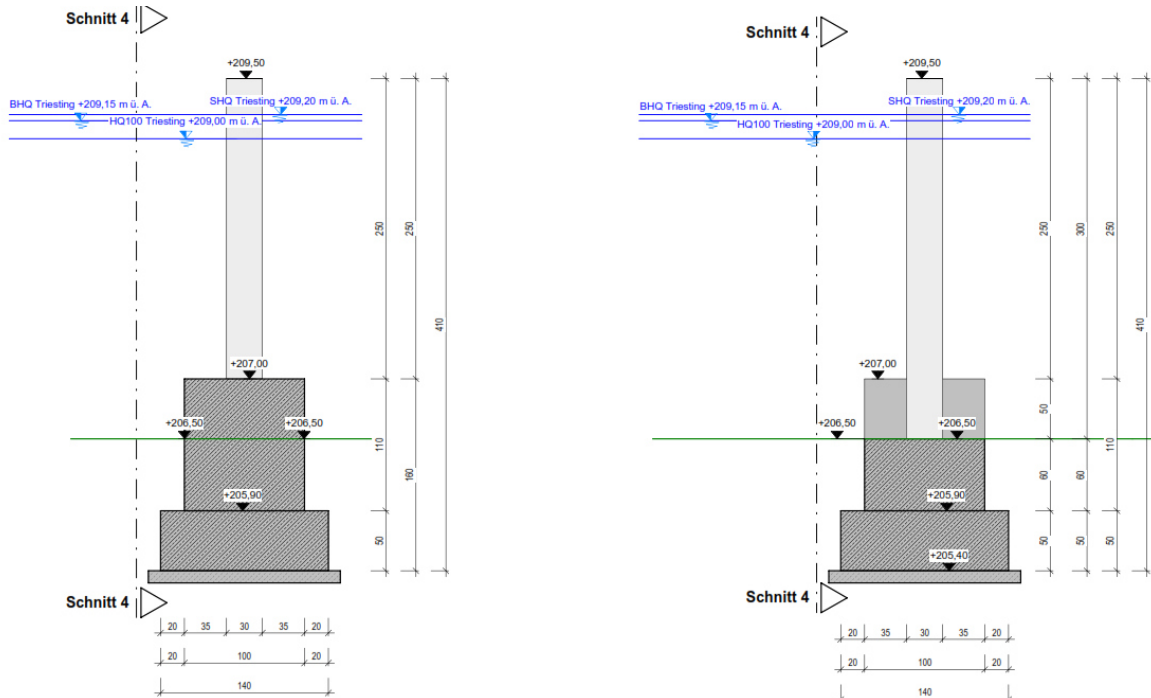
Schnitt durch den Wildholzrechen an der Triesting; aus [10]
